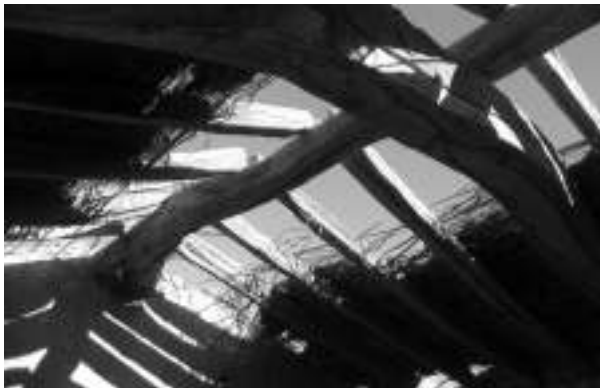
Armazón de cubierta con vigas de algarrobo en una casa de la Finca Potrero.
